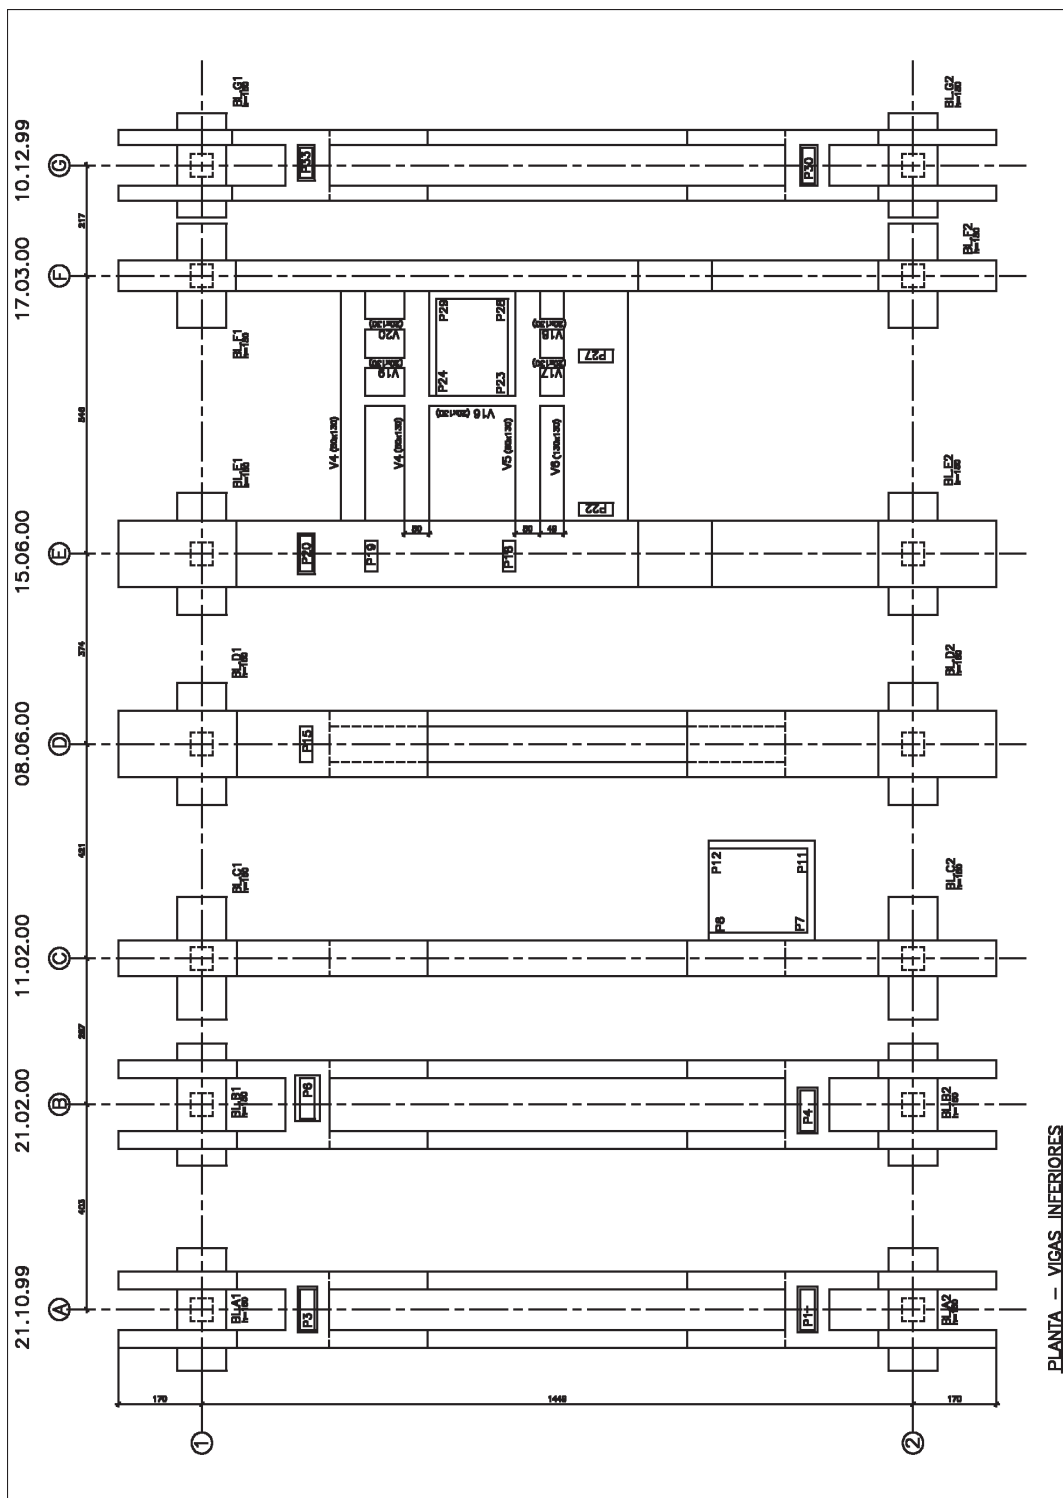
Planta com a localização e datas de concretagem das vigas principais. Banzos inferiores.
